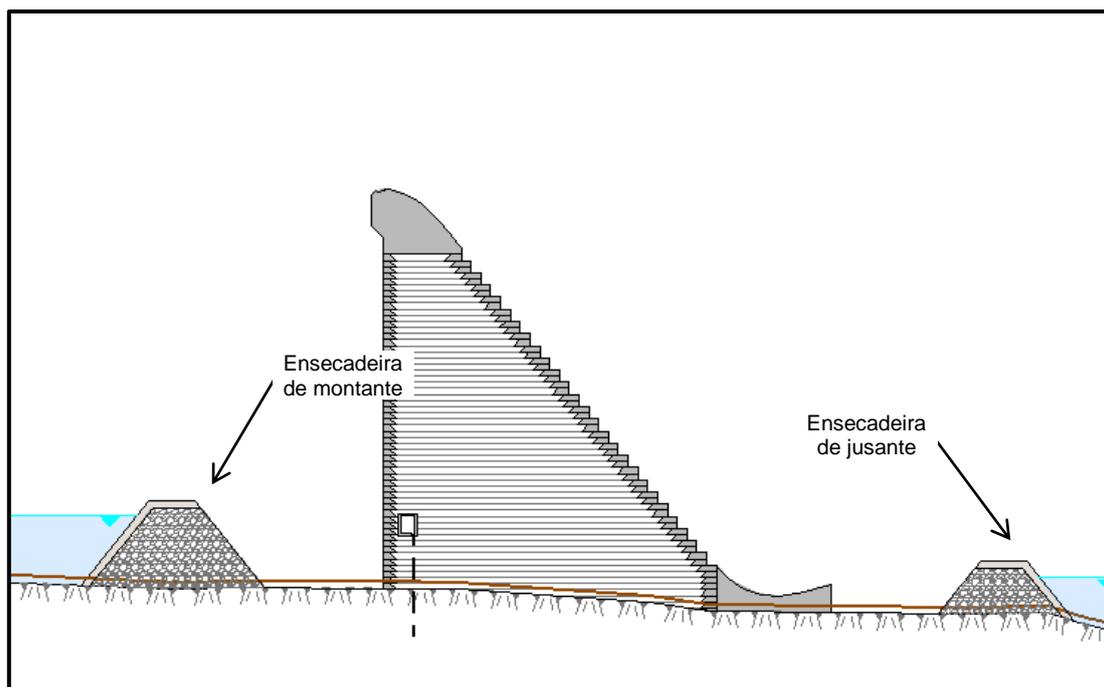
Adufas e ensecadeiras – segunda fase de desvio do rio.
